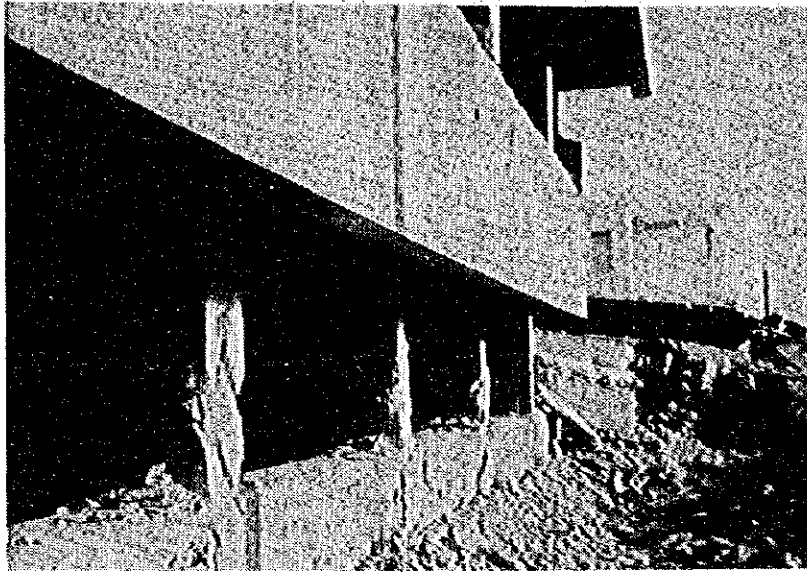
Ruptures des piliers courts du niveau d'établissement souterrain.
